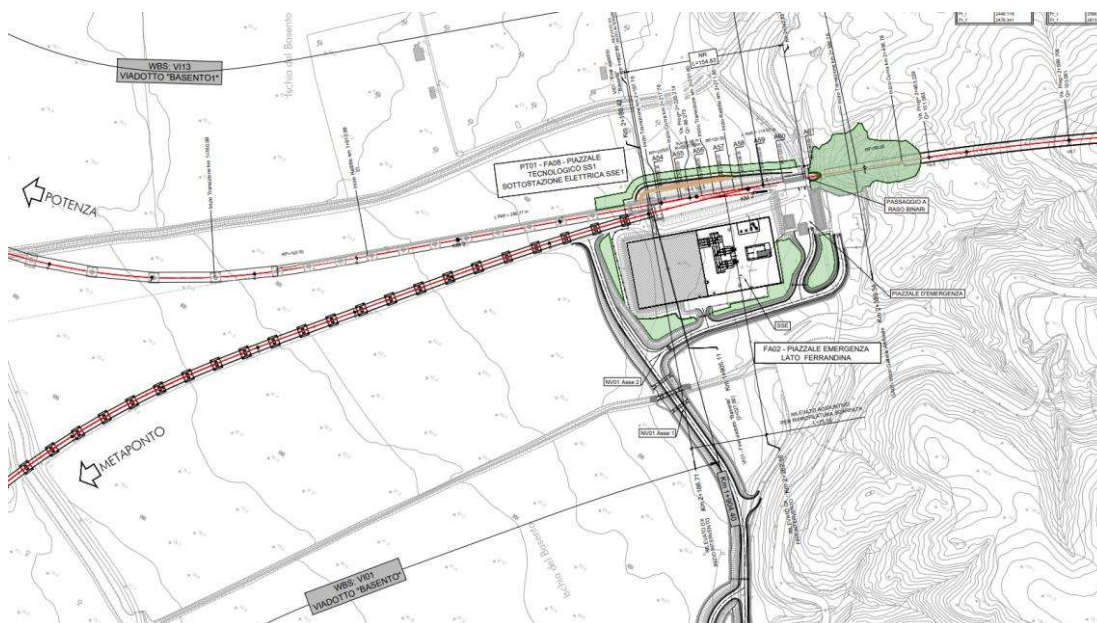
Stralcio planimetria di Progetto Definitivo Ferrandina Matera La Martella
